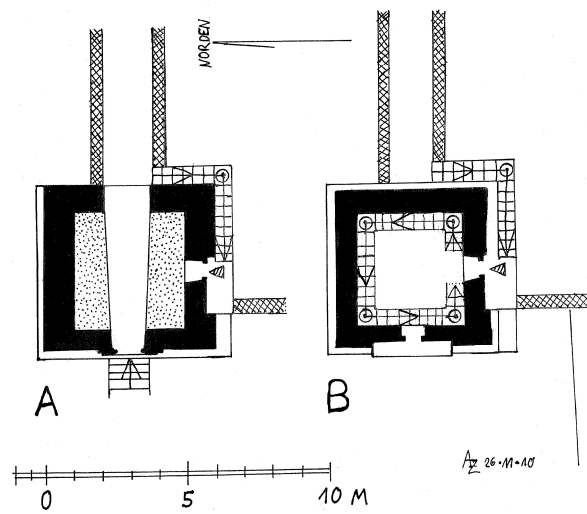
/5: *Campanile*, Grundriss A (Erdgeschoss); Grundriss B (1. Obergeschoss)
